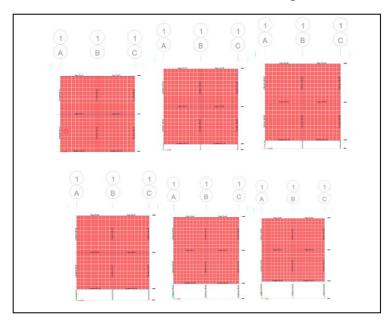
Modelo Estructural de hormigón armado de dos pisos
